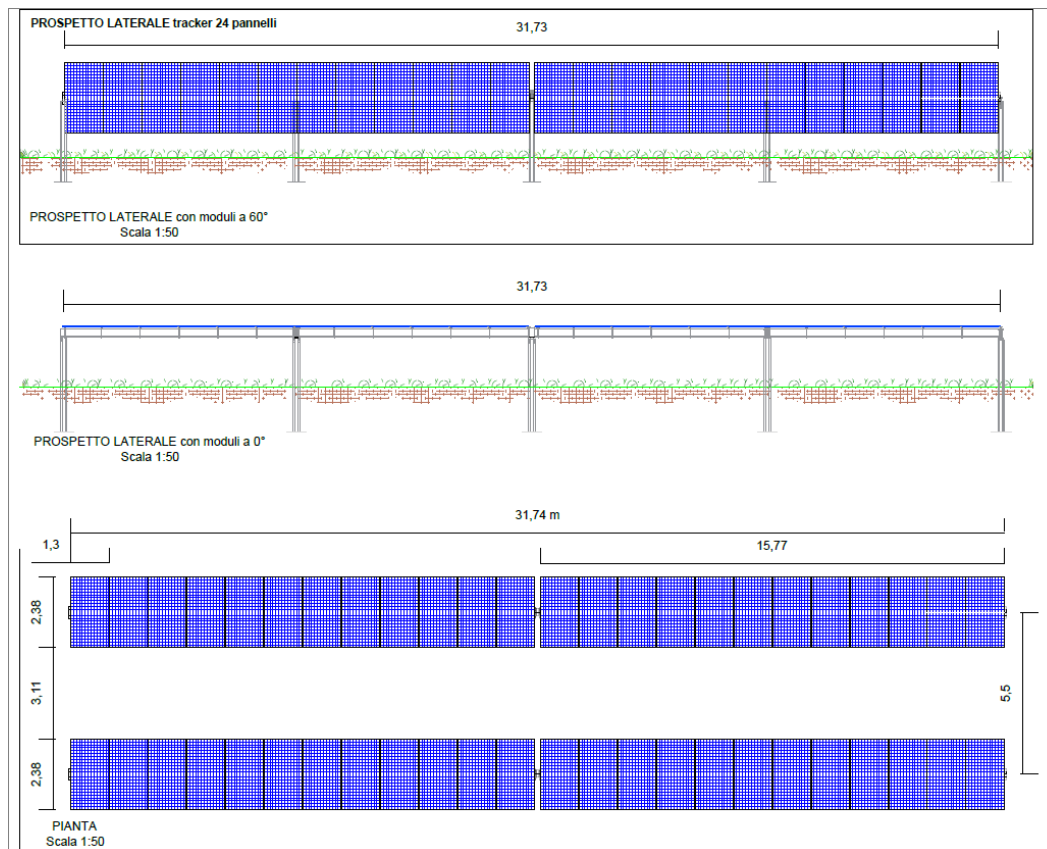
Vista in pianta e laterale delle strutture tipo tracker da 24 moduli previste a progetto
